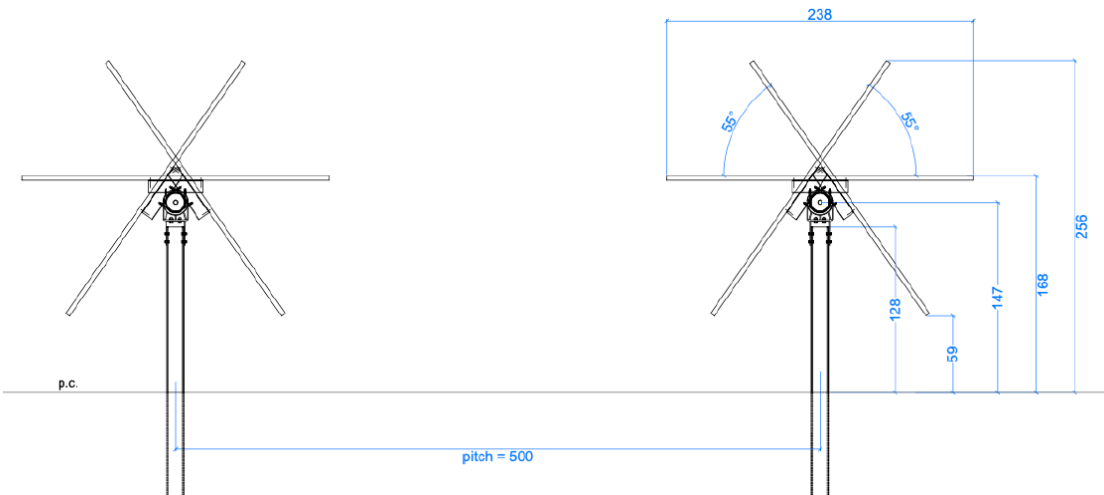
Sezione tipo delle stringhe fotovoltaiche tracker singola vela.
